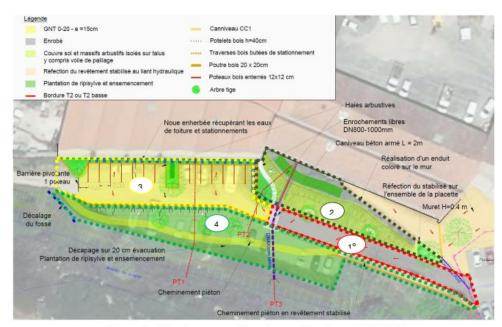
Plan de composition d'ensemble du projet (PA3.1)
